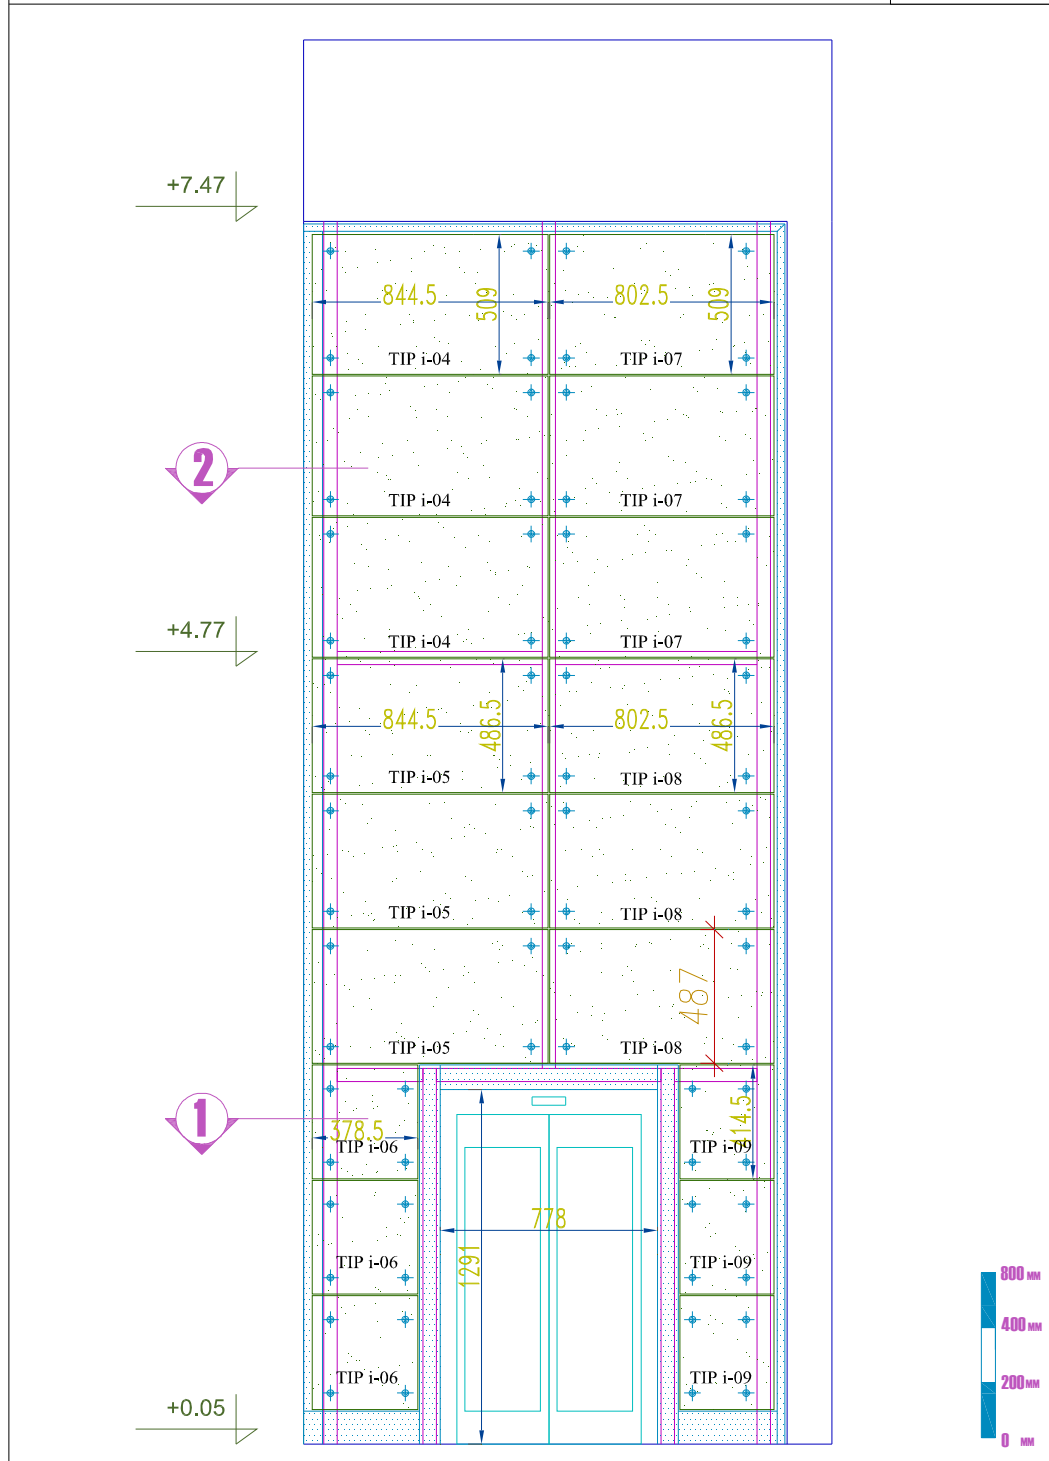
Çelik taşıyıcılı transparan cephe planı ve sistem detayı
